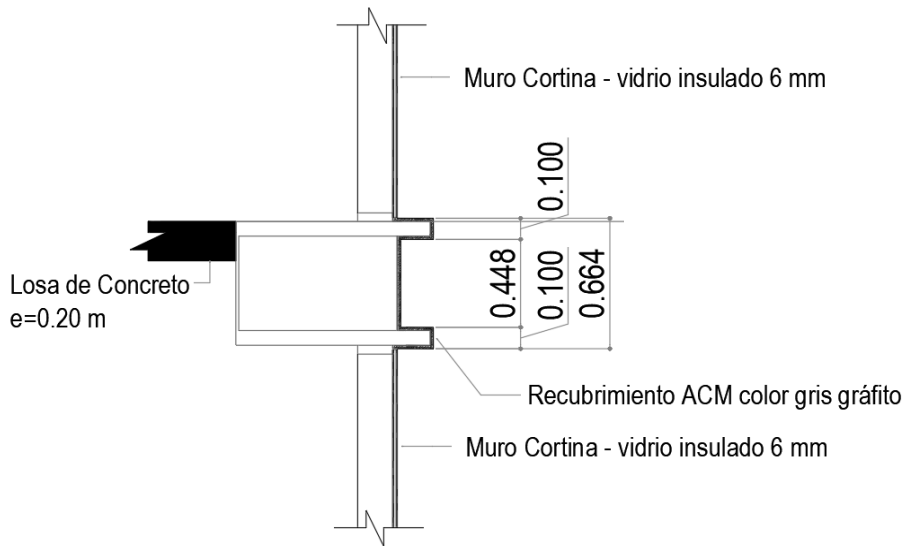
Elementos de ACM en fachada Norte y Oeste Hotel Courtyard
